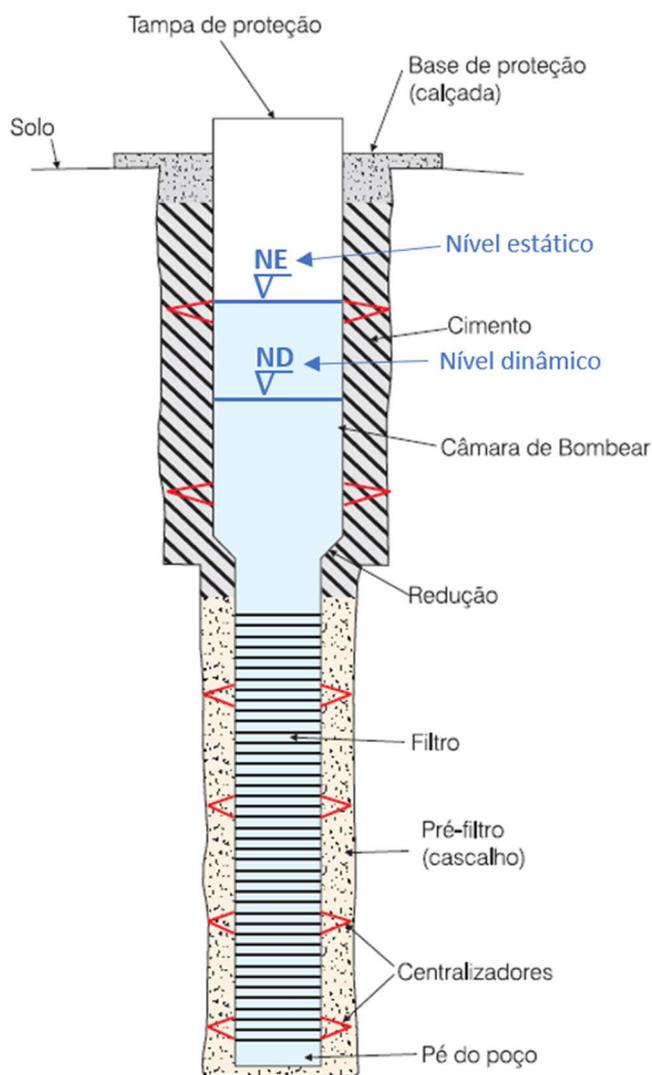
Exemplo de perfil construtivo de um poço. Fonte: Adaptado de Feitosa et al. (2008).
